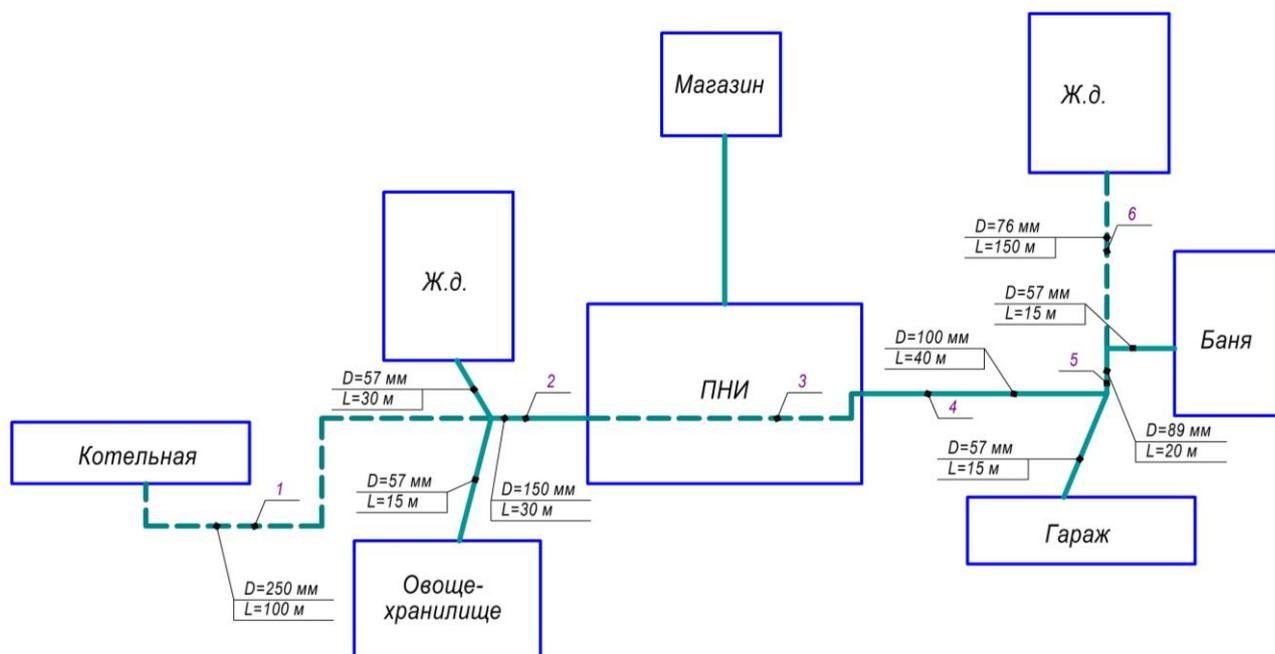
Схема тепловых сетей котельной №6
